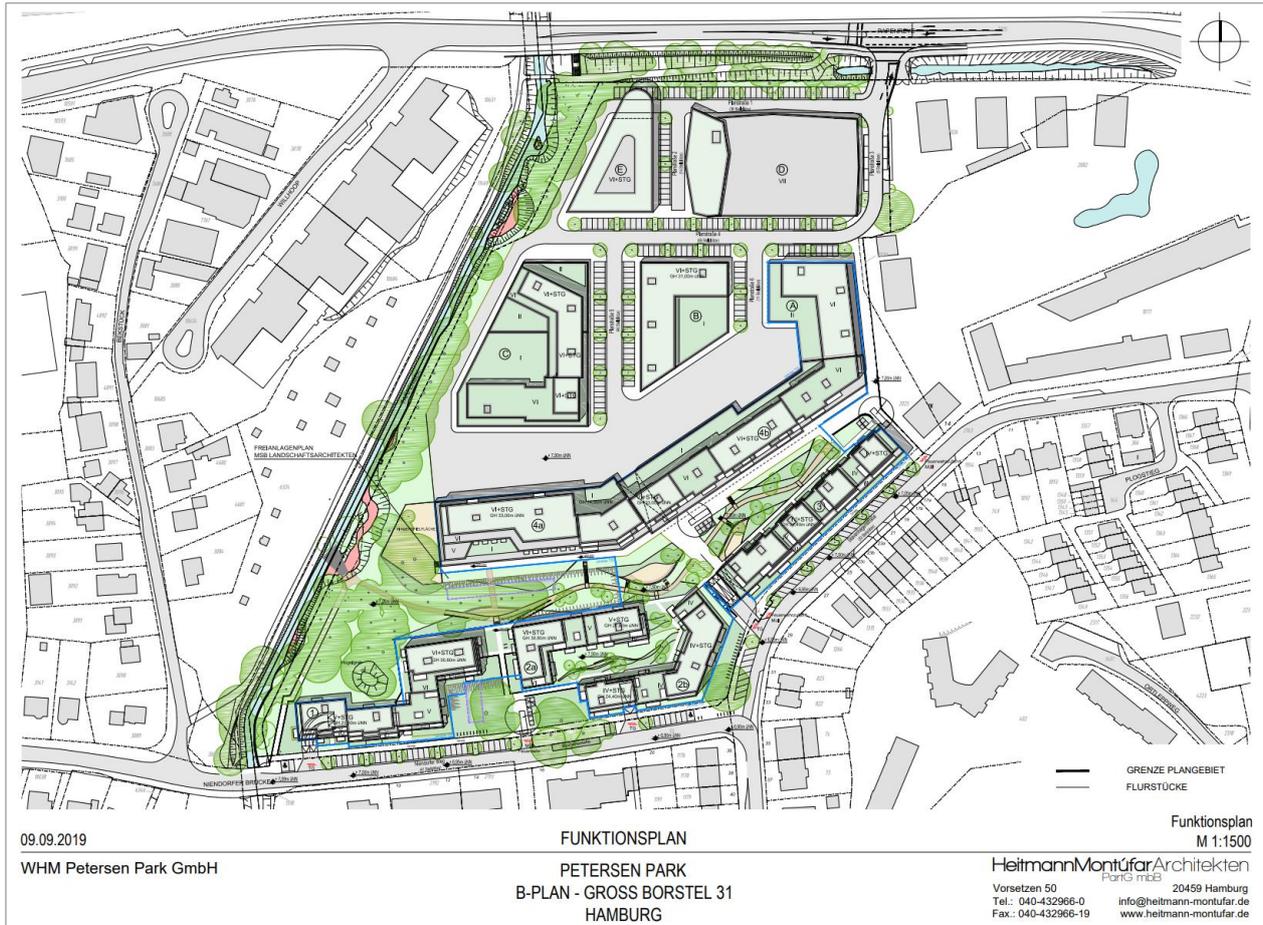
Funktionsplan Stand 03/2018 - B-Planverfahren Groß Borstel 31, Petersen Park (Quelle: BA-N)
